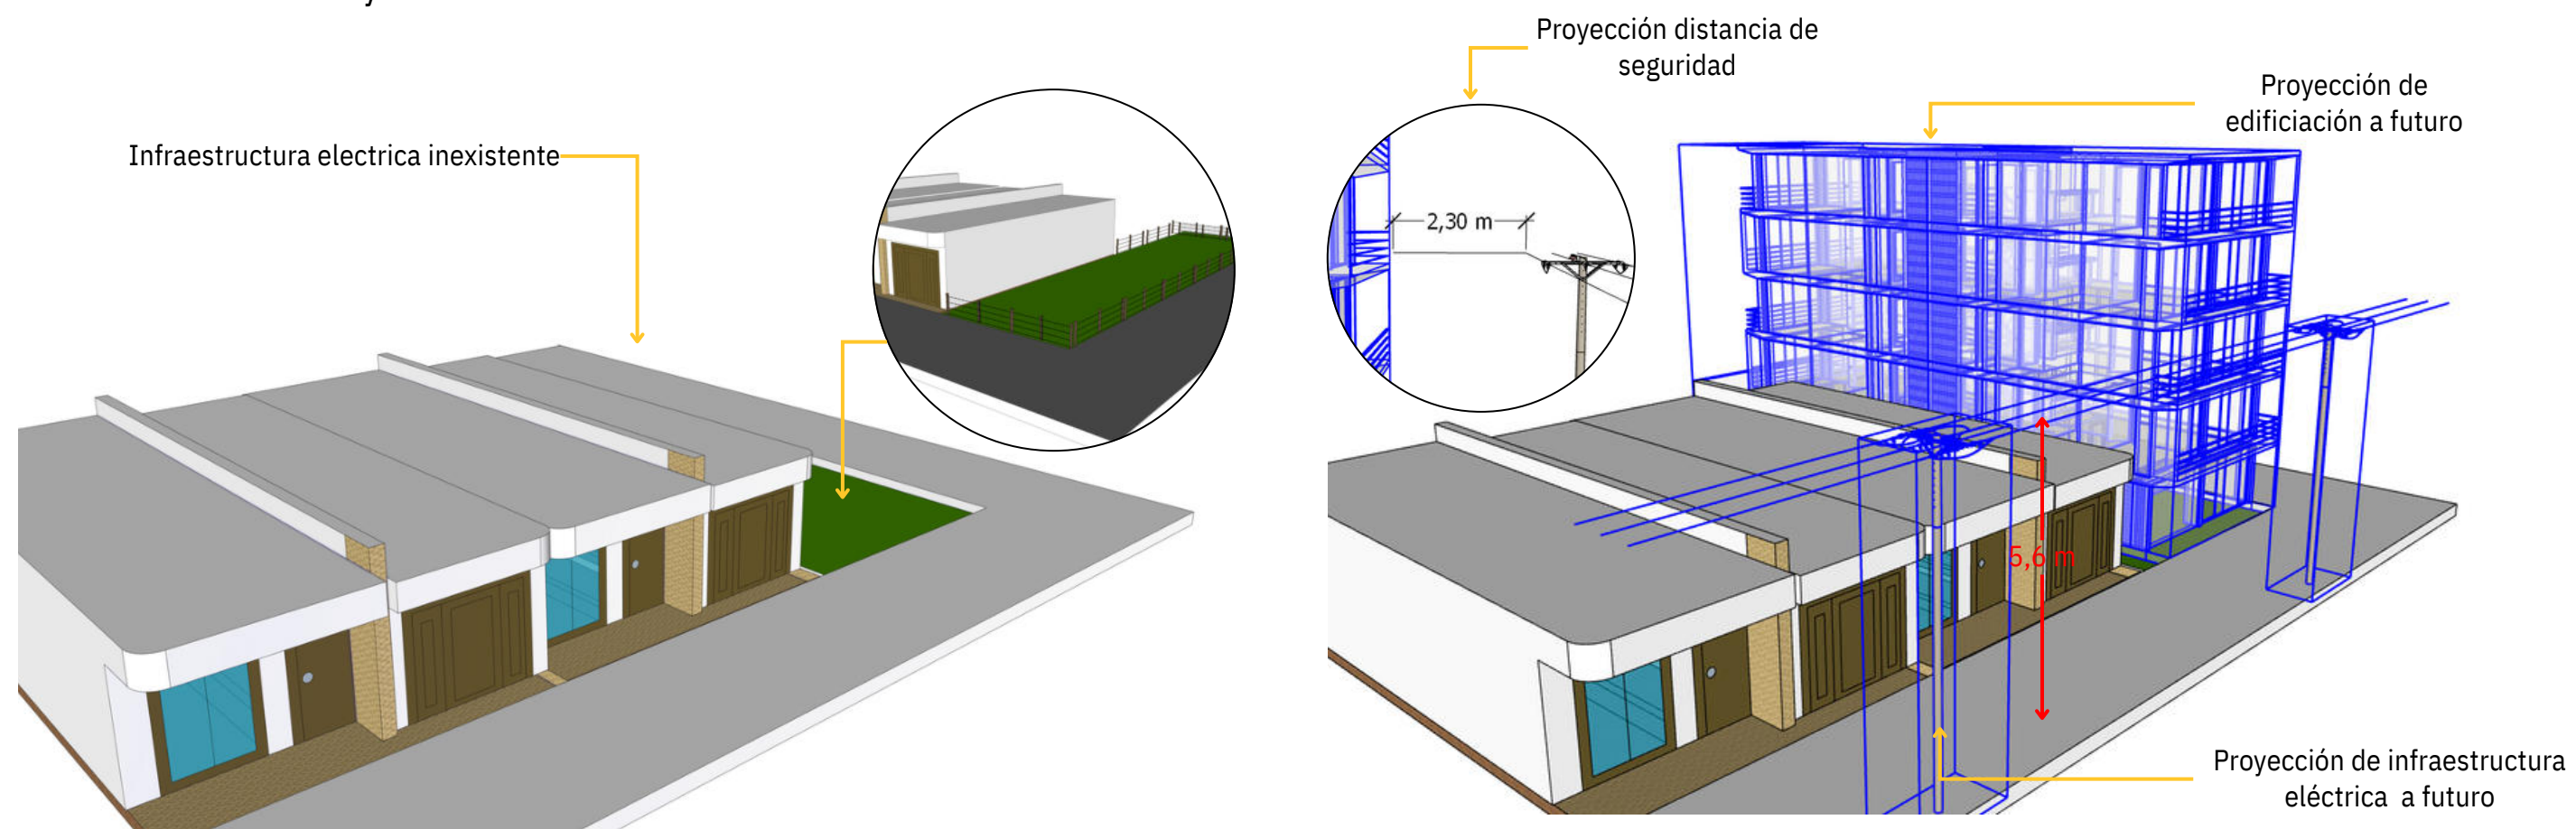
Distancias mínimas de seguridad en zonas con construcciones con infraestructura eléctrica inexistente.
